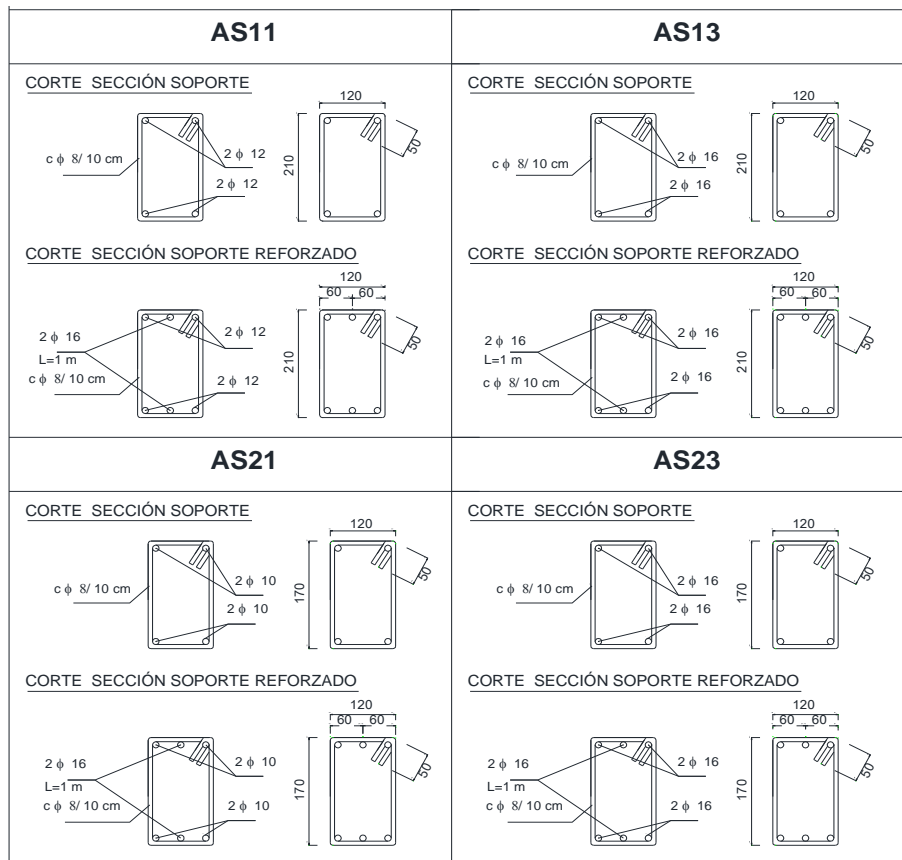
Secciones tipo de ferralla (parte 1 de 2)
